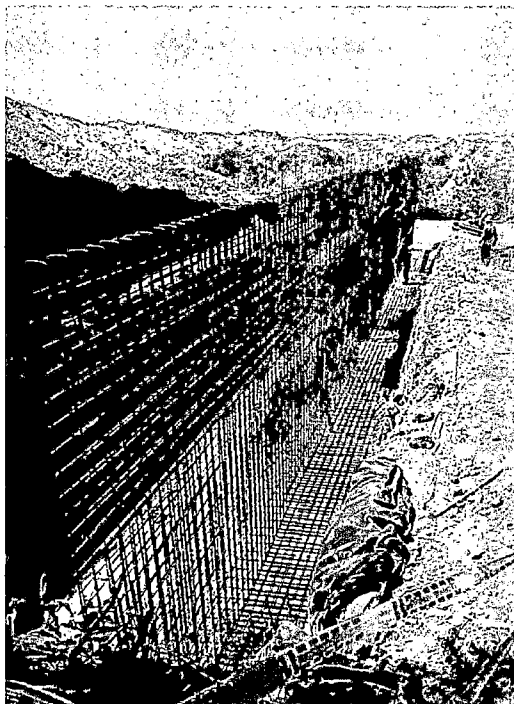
COLOCACION ACERO LOSA DE CIMENTACION DE MURO ALTO
